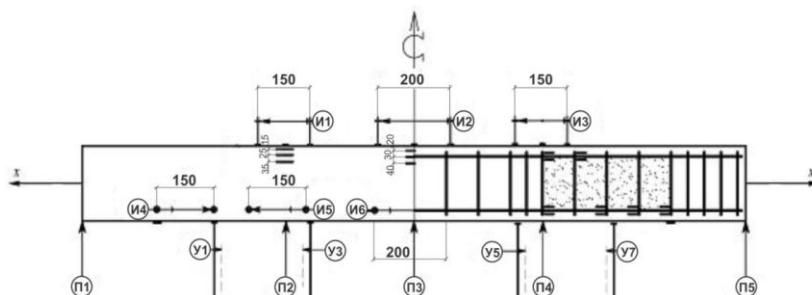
Схема армування, розстановки приладів і випробування дослідної балки
